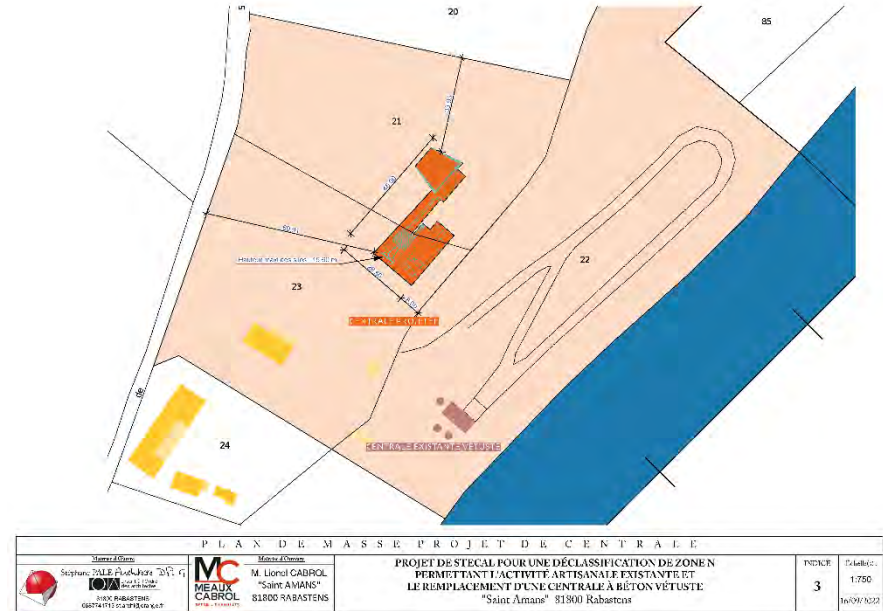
plan de masse du projet à l'étude, source Stéphane Palé architecte
